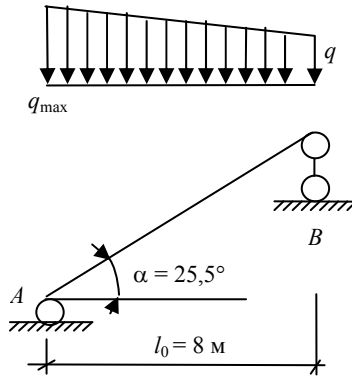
Расчетная схема плиты при расчете на монтажные нагрузки
